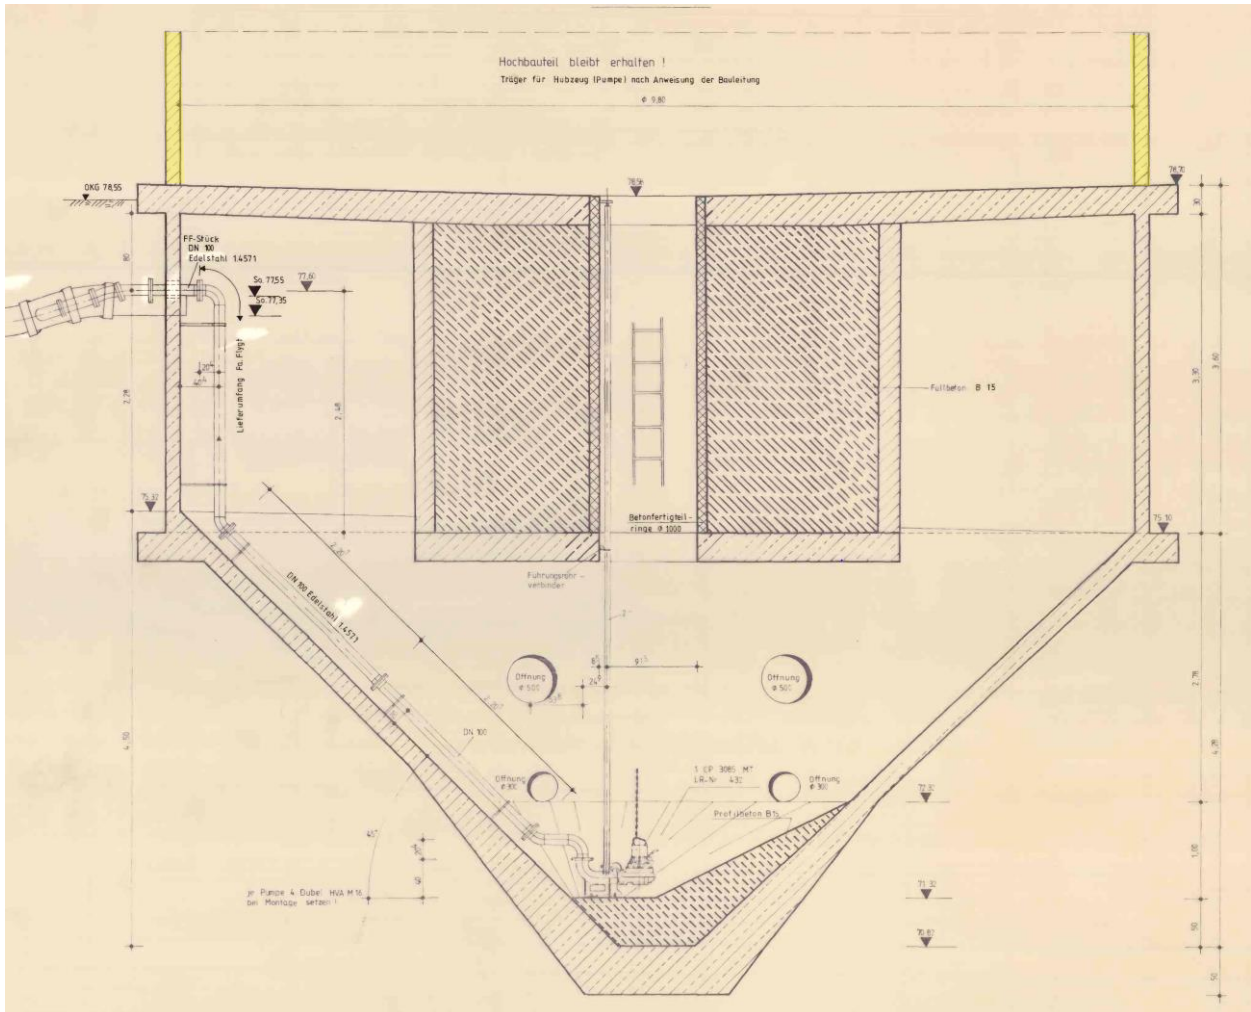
Schnitt A-A durch den unterirdischen Bereich des Tropfkörpers mit Markierung der abzubrechenden Bauteile, Bauteile des Tropfkörpers oberhalb der GOK nicht vollständig dargestellt.
